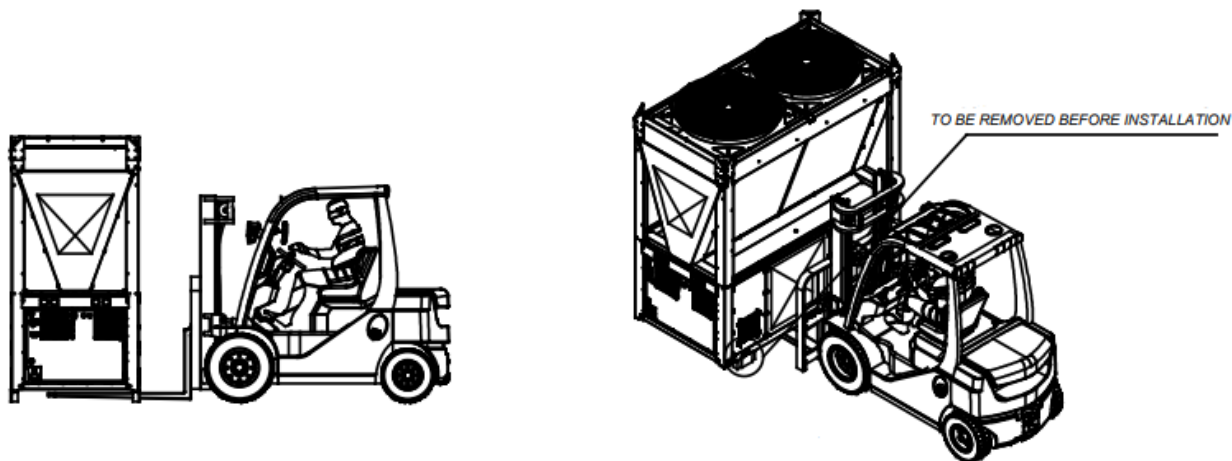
Istruzioni di sollevamento con carrello elevatore
